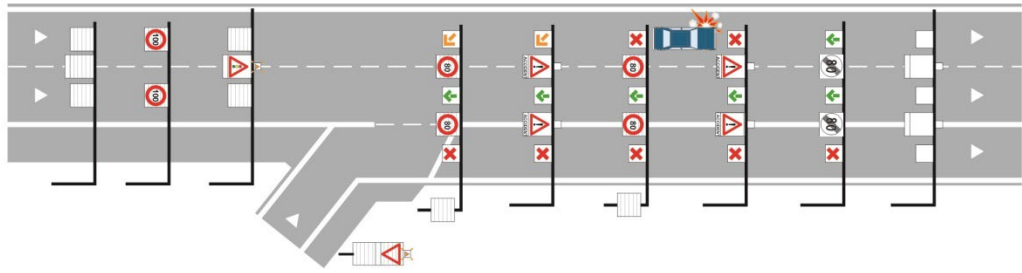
33.1 BAU fermée : événement sur la voie de dépassement.
